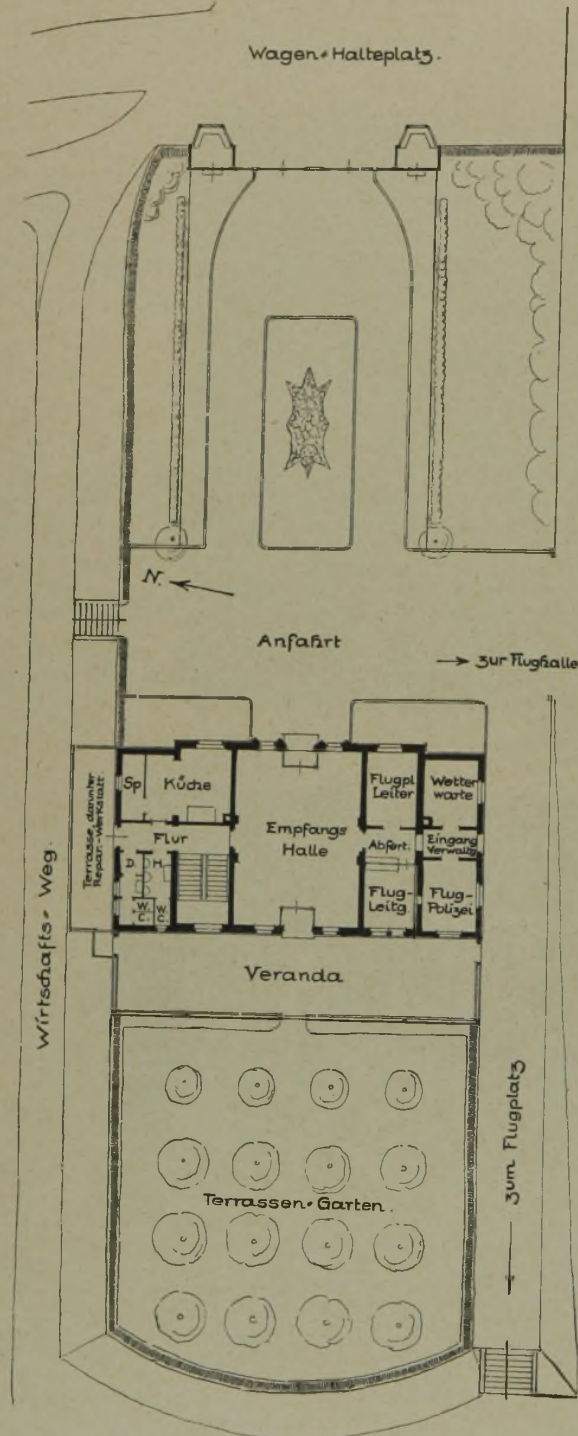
Plan der Anfahrt zum Flughafen mit Grundriß des Verwaltungsgebäudes. (Maßstab 1:400)
